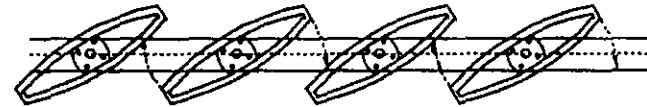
Posible sistema de protección contra huracanes. Planta de láminas verticales móviles.
